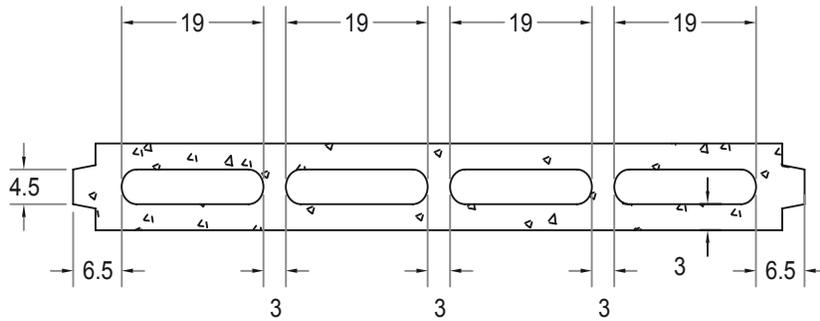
Vista en planta del bloque 3/4 de 75 cm con sus respectivas dimensiones nominales.
